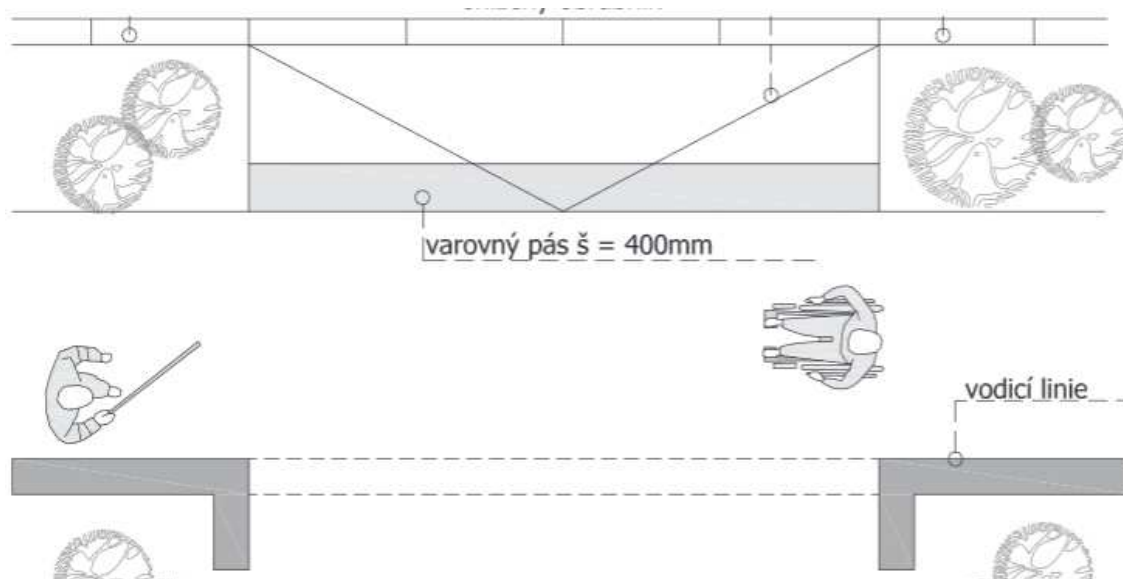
Způsob realizace přechodu pro chodce ve stísněných podmínkách [9]
